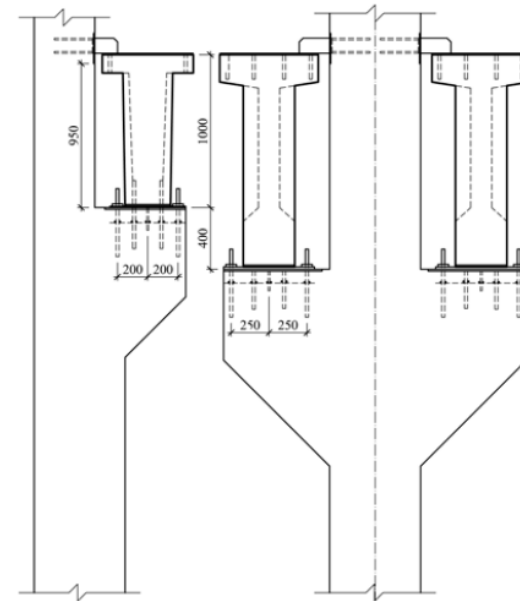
Кріплення залізобетонних ПБ до консолей колон
